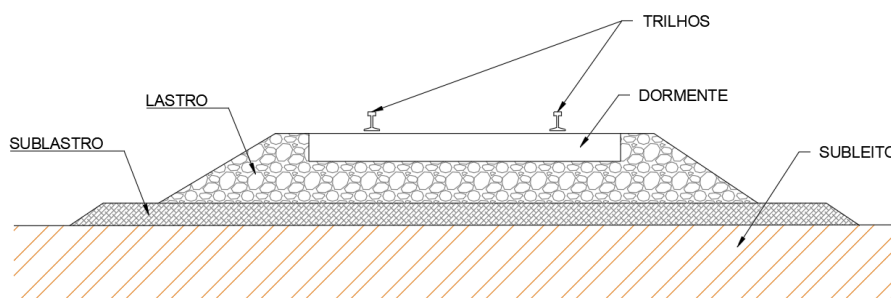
Seção típica do pavimento ferroviário (elaborado pelo autor)
